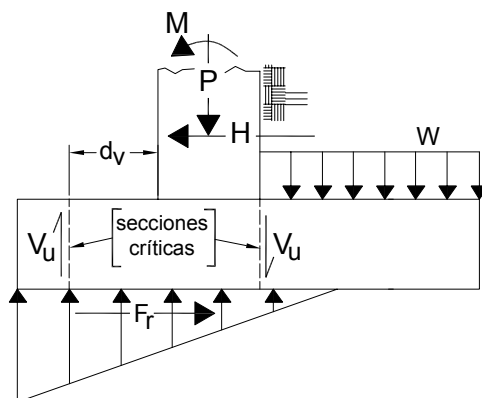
Ejemplo de secciones críticas para corte en zapatas
